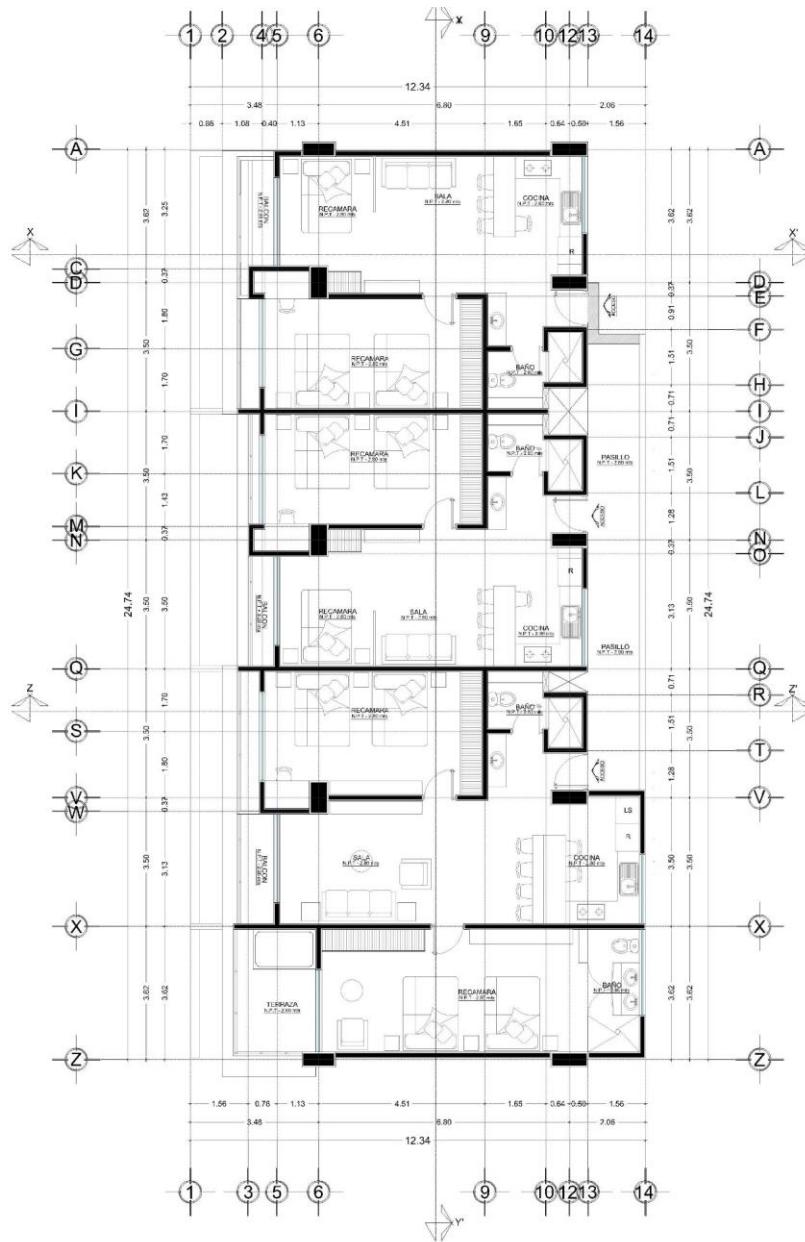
Planta arquitectónica del Sótano 1 Edificio A.
